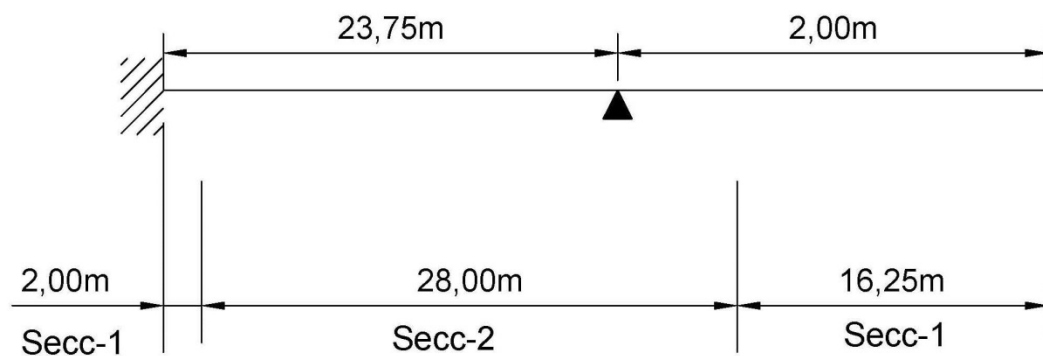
Esquema estructural y tipos de sección transversal considerados.
